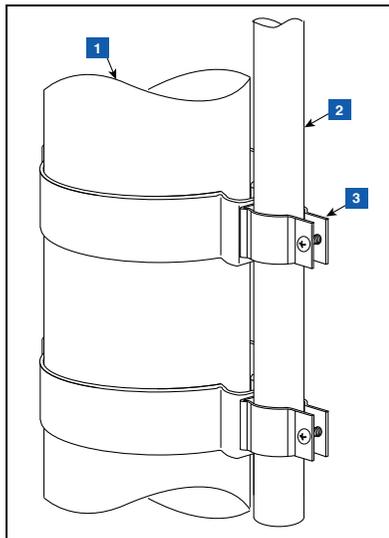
Fixation du conduit de 12,7 mm à la bride de 12,7 mm sur le tuyau ascendant
